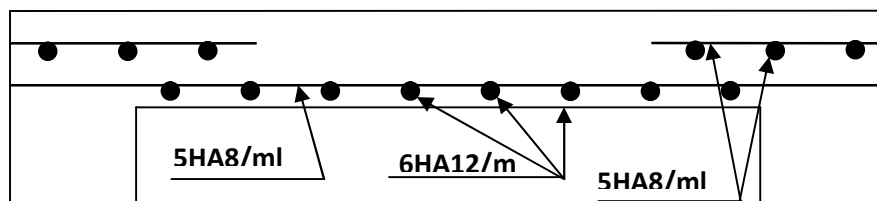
Schéma de ferrailage du quatrième type de balcon.
